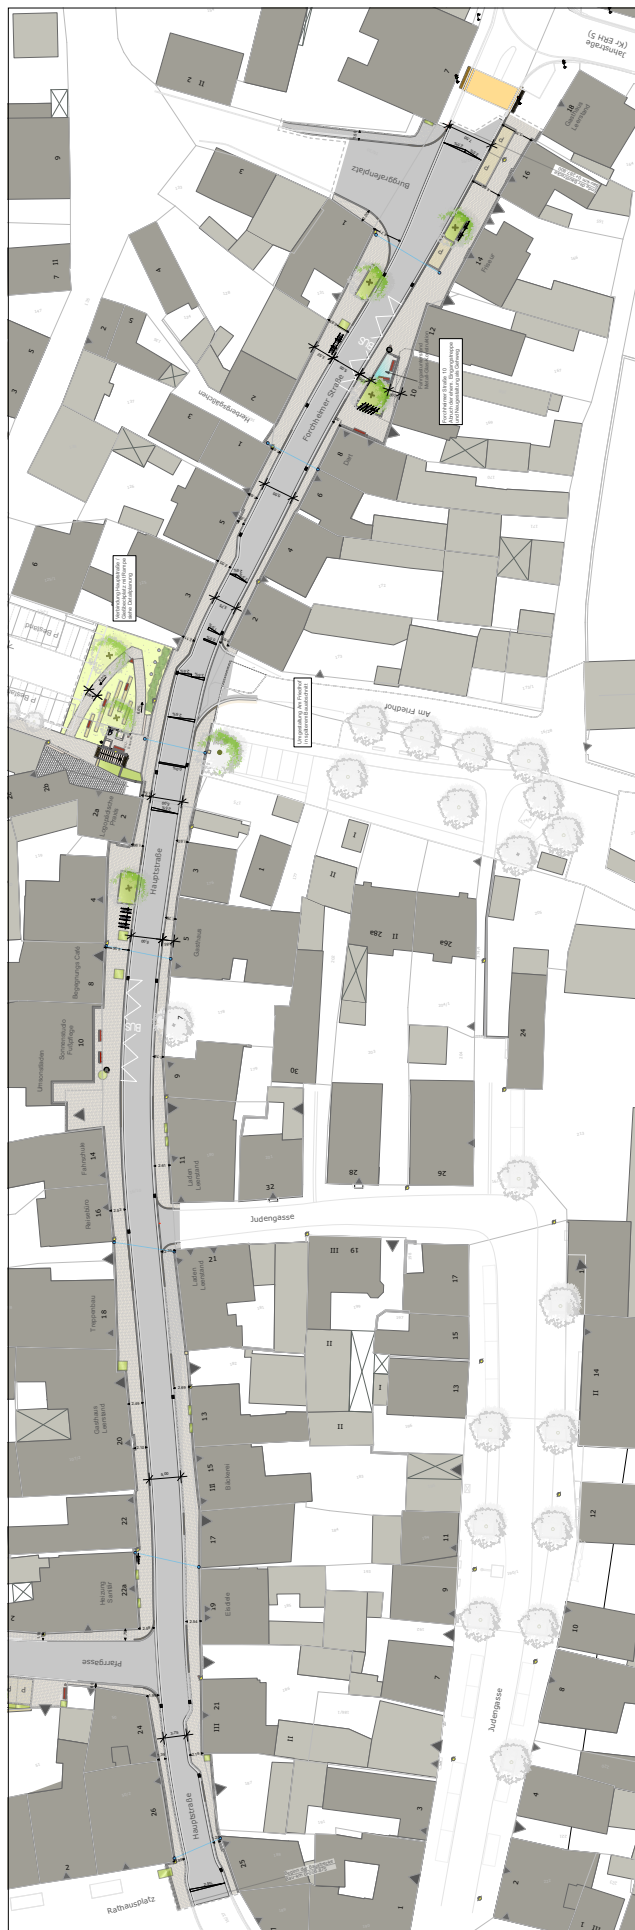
Plan für die gerade durchgeführte Umgestaltung der Hauptstraße (*)
